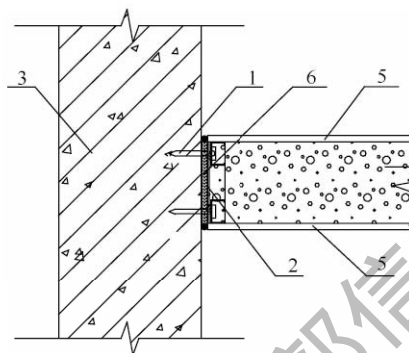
复合墙体与主体墙或柱连接示意图
